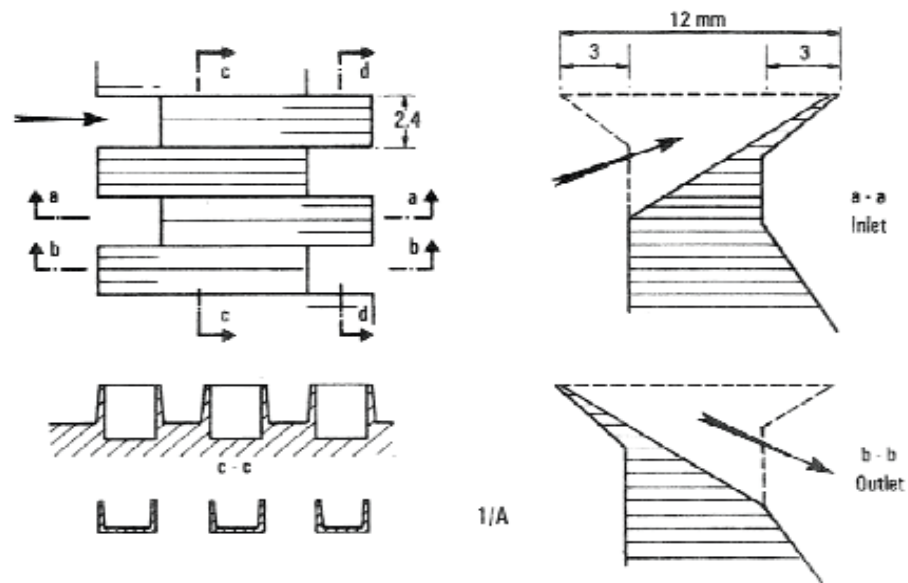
Descarregador em Plano – configuração A (retirado de Schleiss, 2011).
